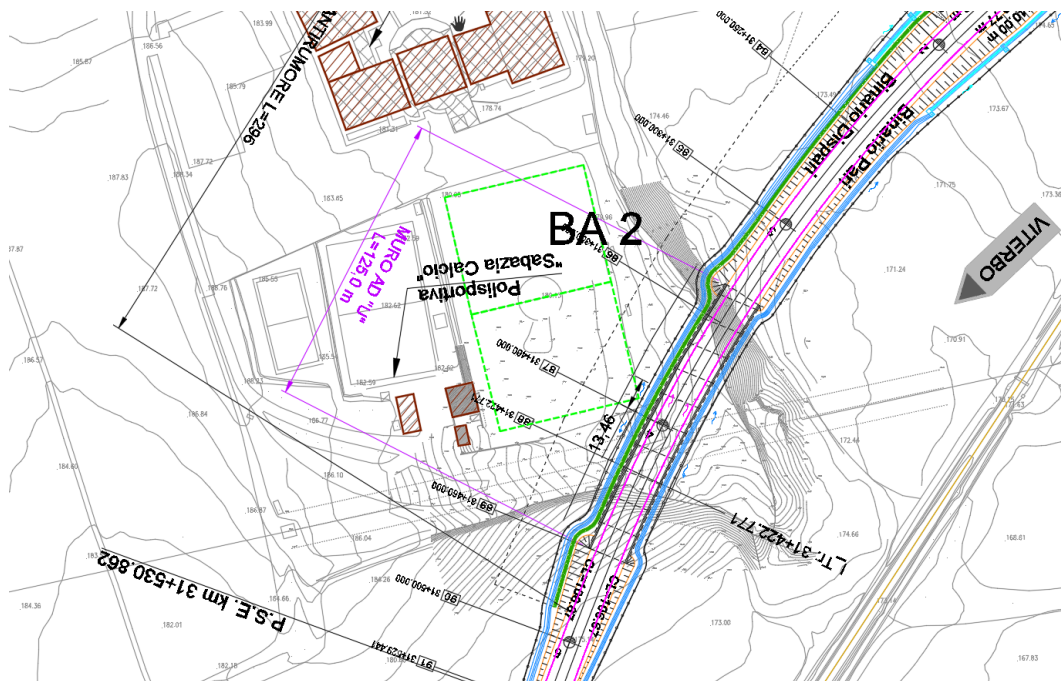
Muro ad U: inquadramento planimetrico, posizione polisportiva e sondaggio limitrofo
